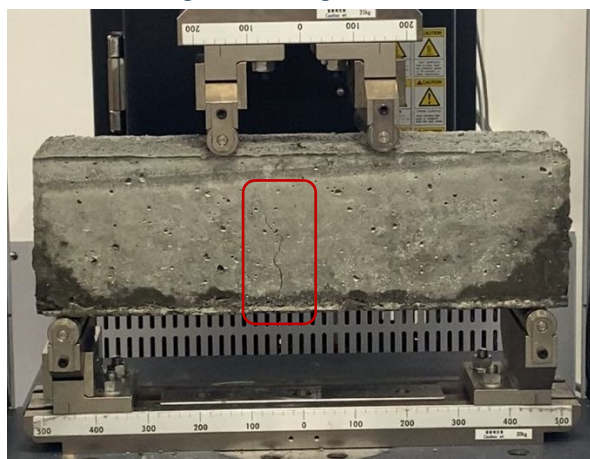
Tipos de fallas en las vigas de hormigón convencional.
